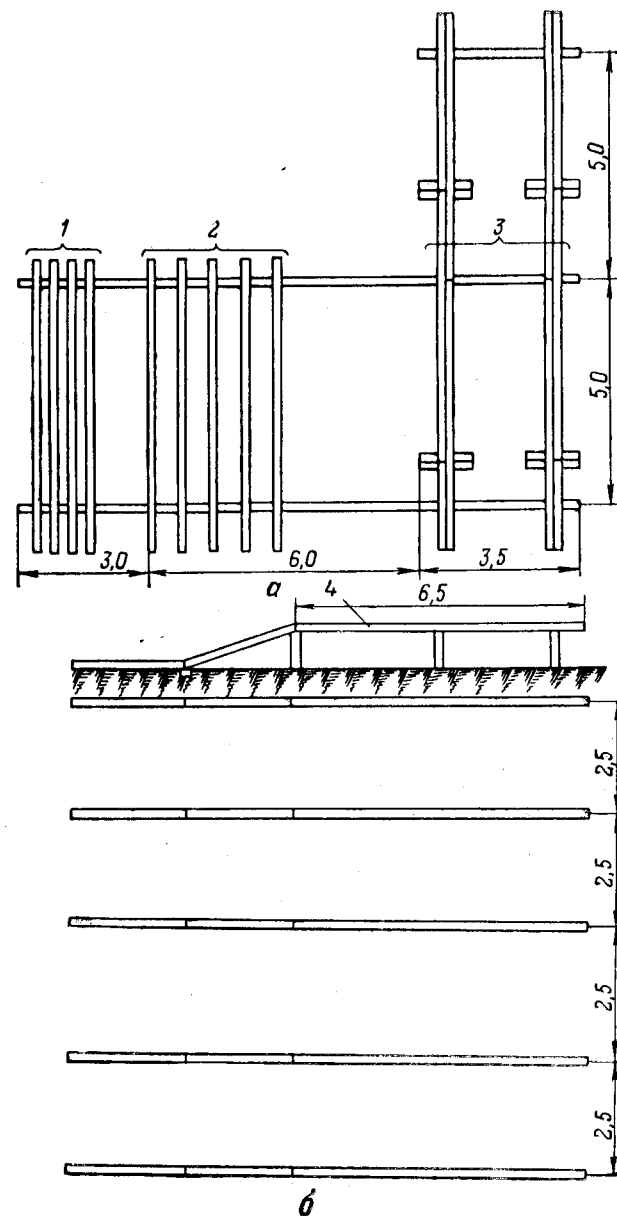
Площадки для изготовления рам деревянной опоры из круглого леса:
